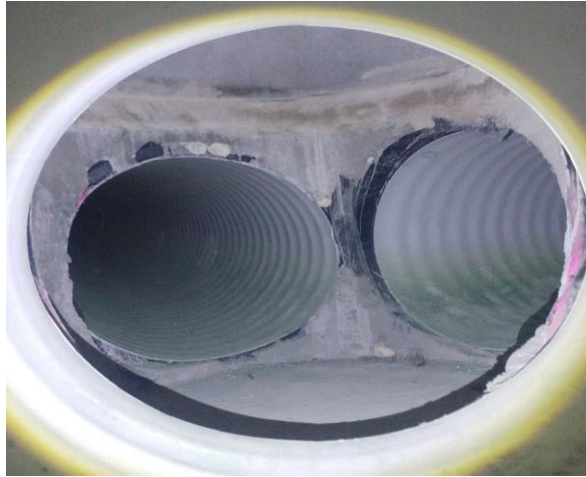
Red de alcantarillas de "Casas Altas". Fuente: Elaboración propia
